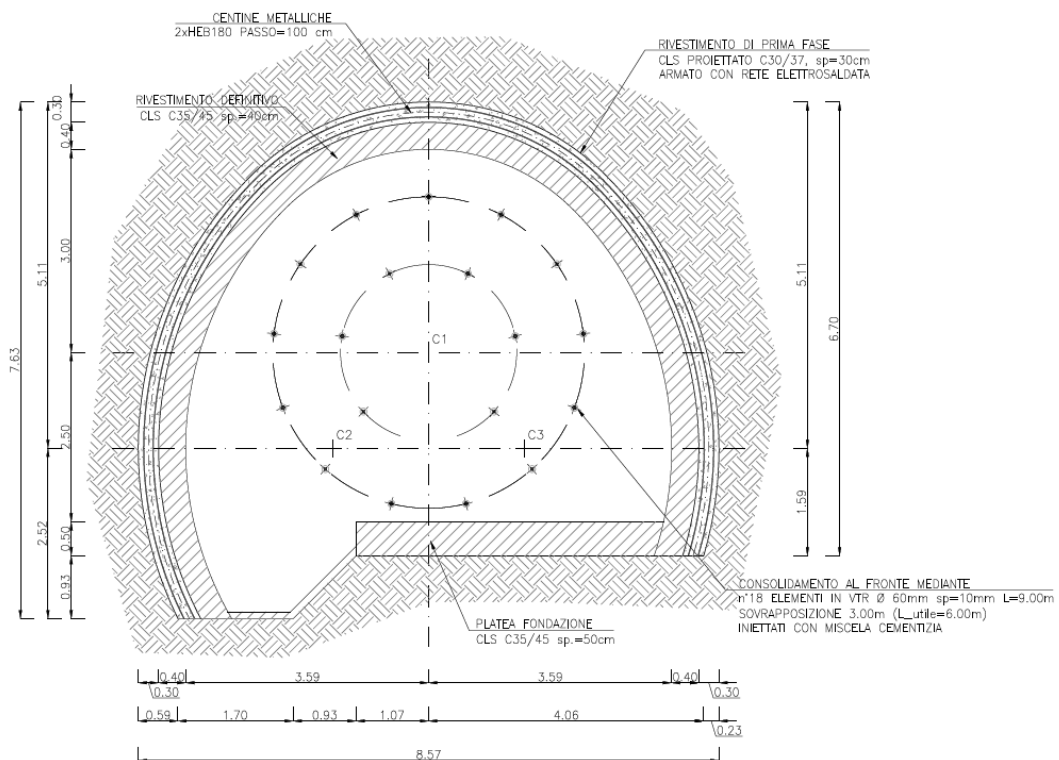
Sezione tipo GV-3: geometria del cavo e interventi di sostegno
